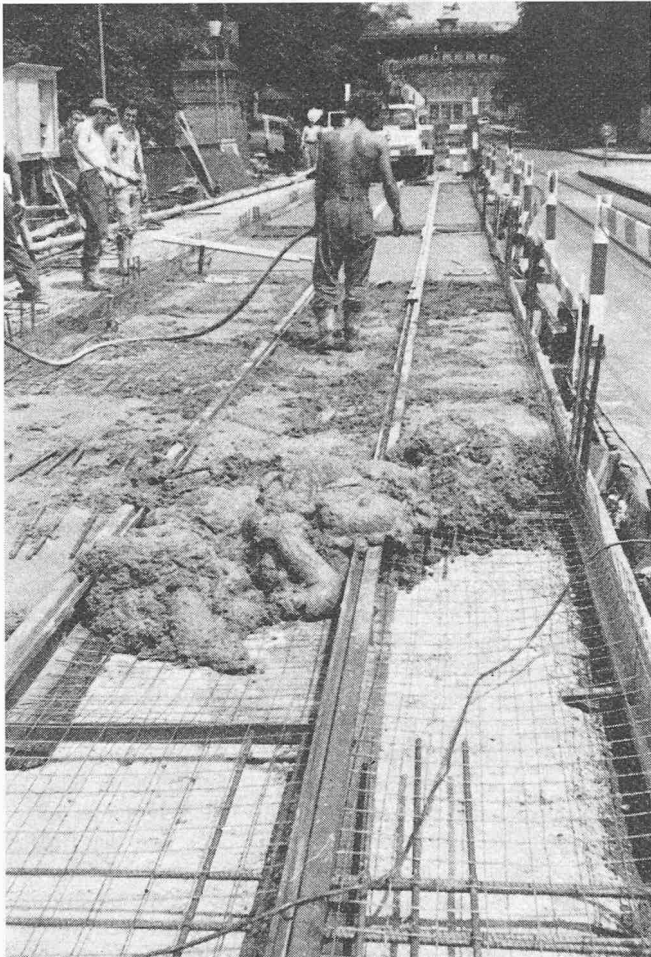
Betonieren der Fahrbahn mittels Betonpumpe
